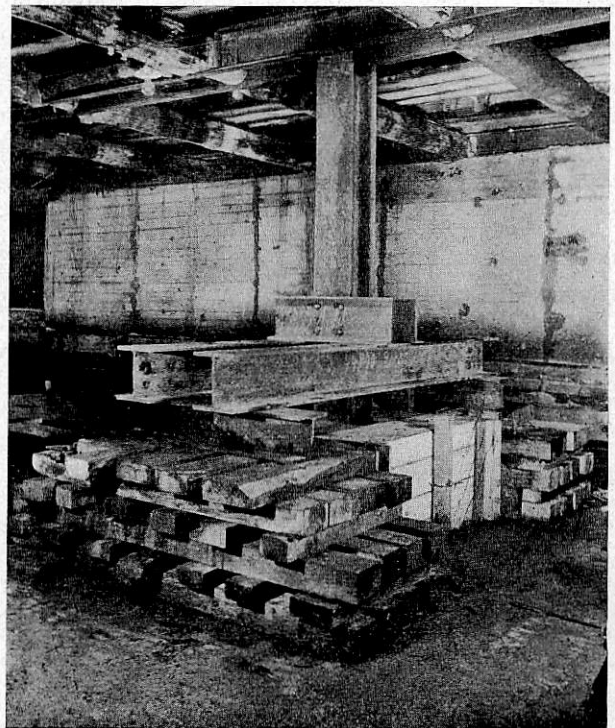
Abfangung eines Mittelrammträgers auf der Tunneldecke.
